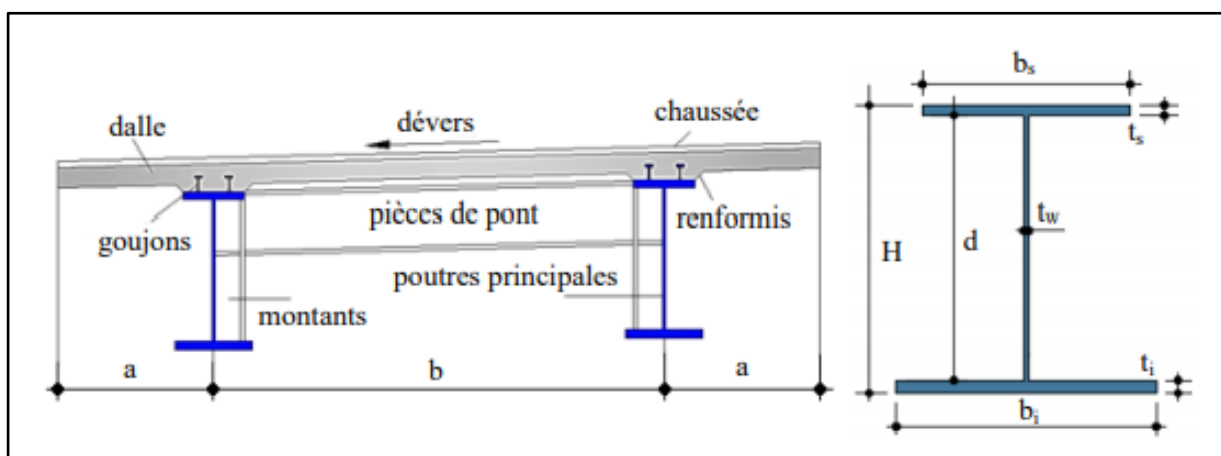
Profil en travers d'un bipoutre à pièces de pont
